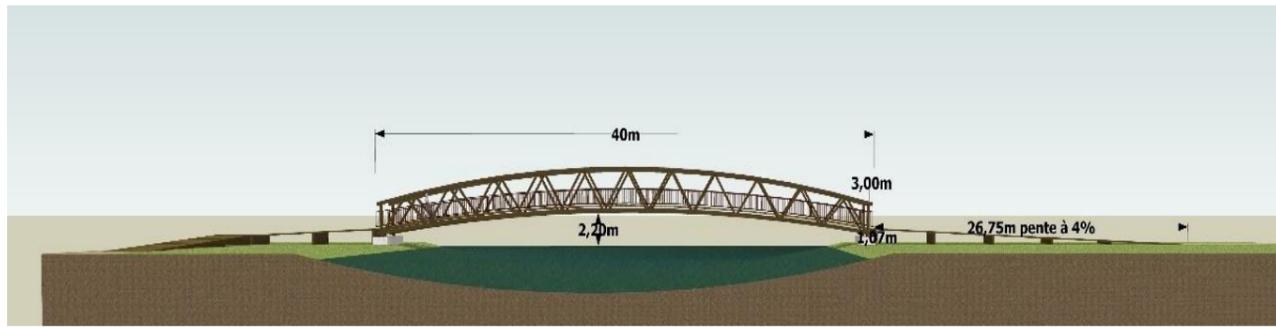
La coupe transversale d'une passerelle avec Rampes d'accès
